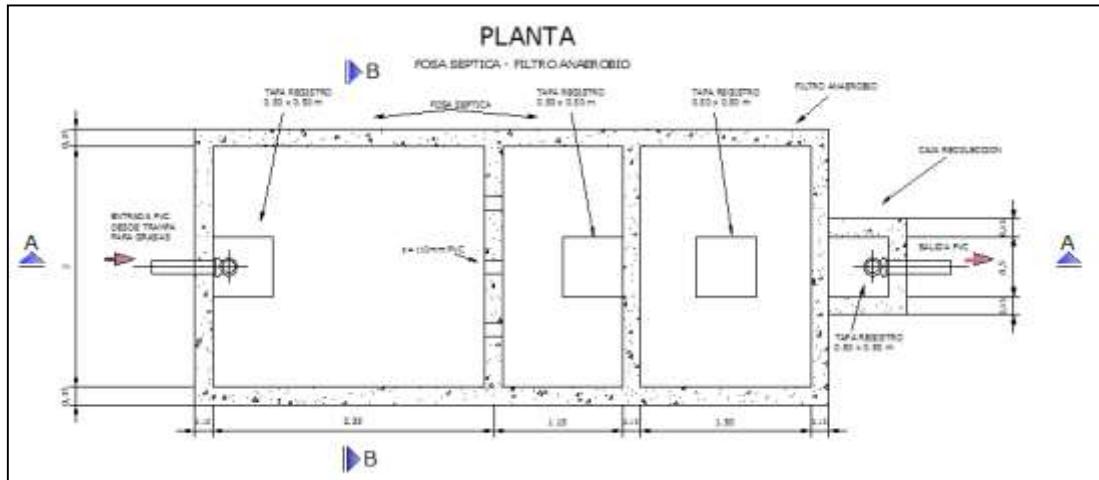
Planta de tratamiento (Campamento Pinos).
